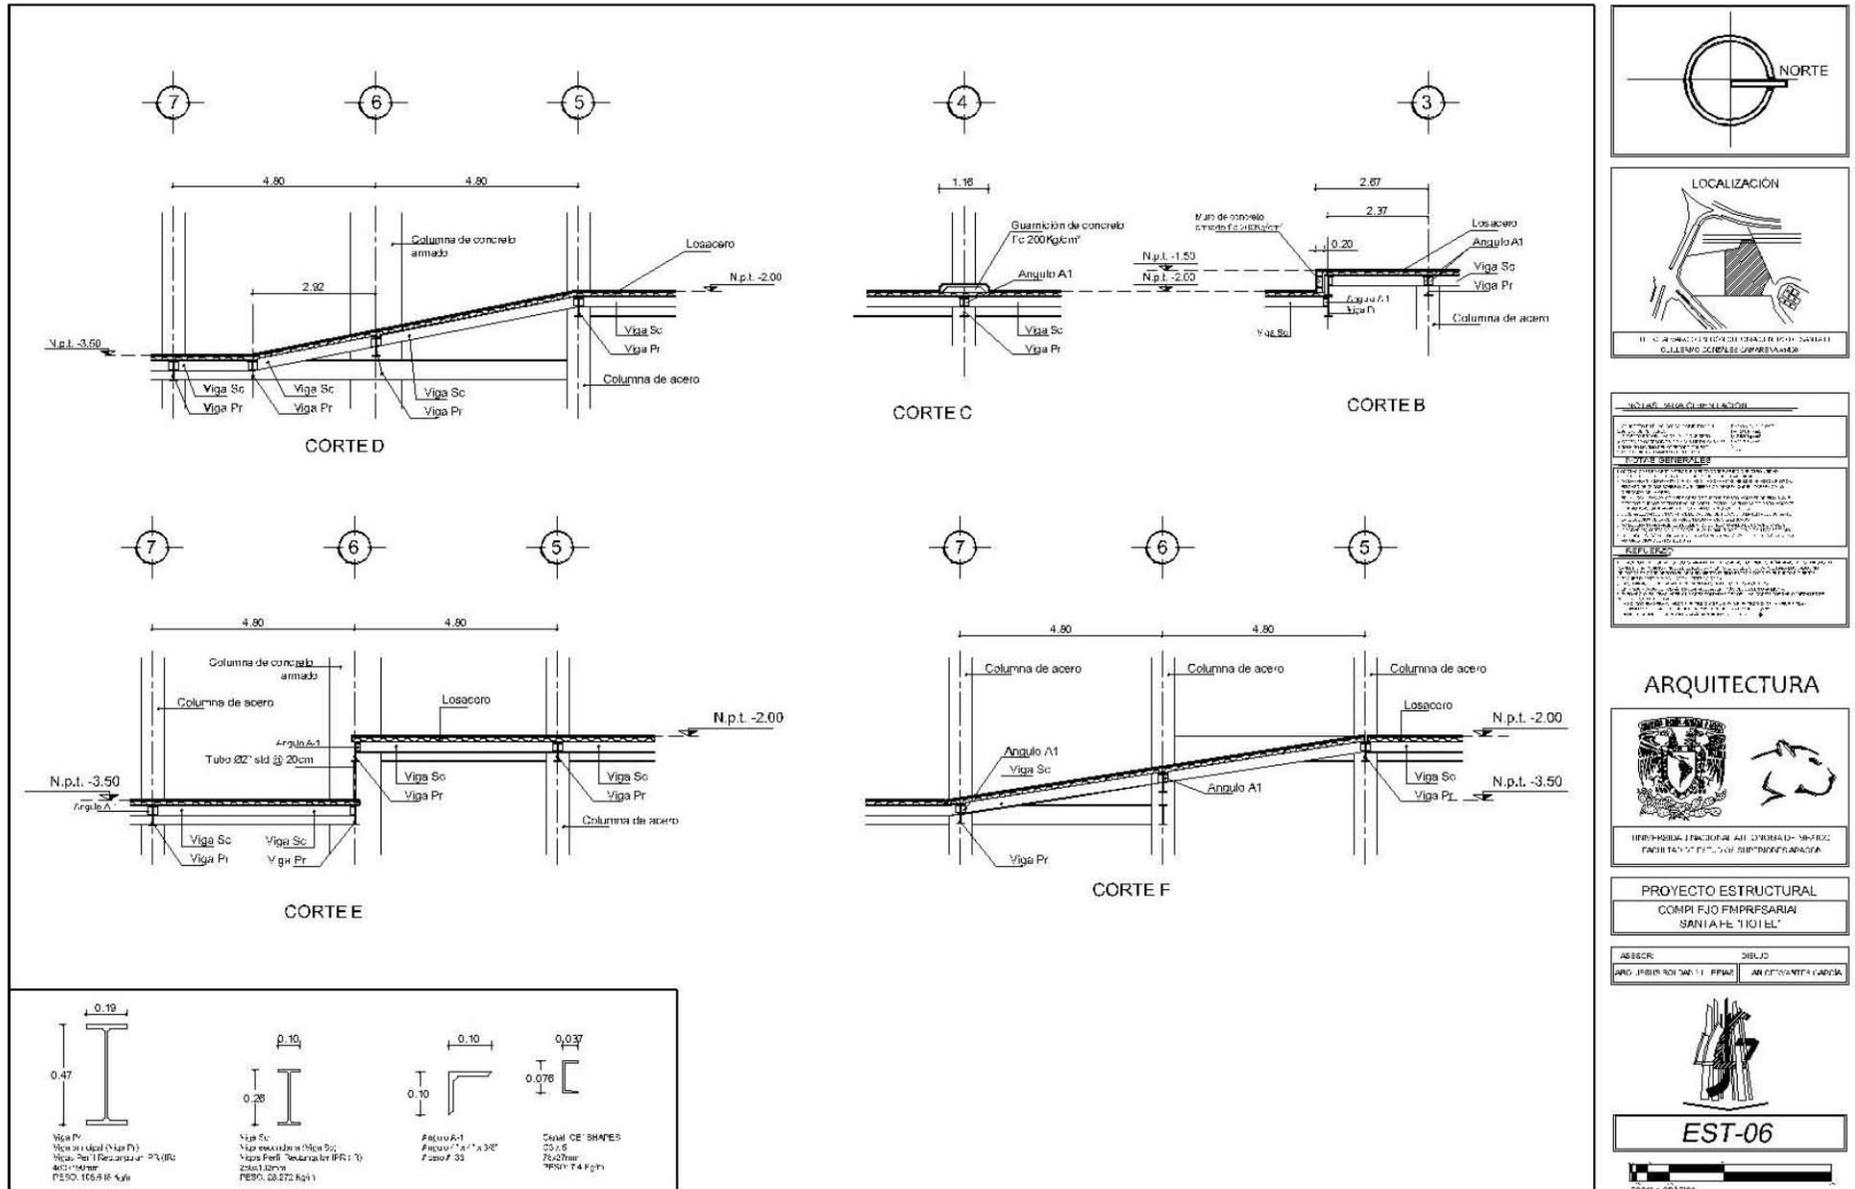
Plano Est-06; Cortes estructurales. Edición propia.
